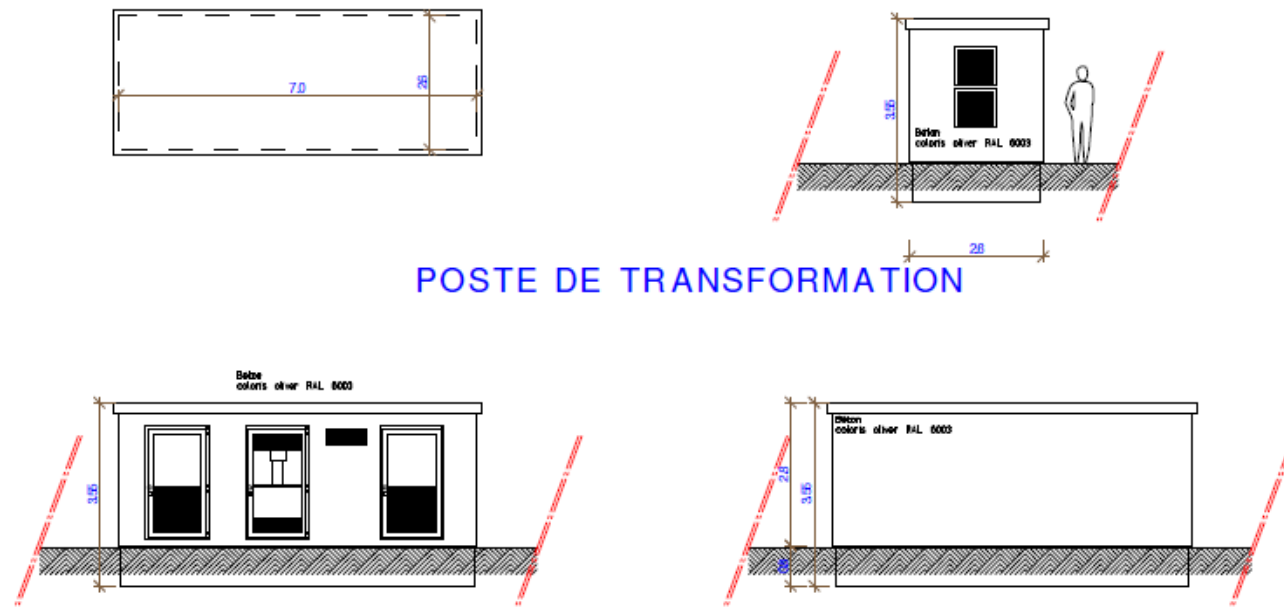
Exemple de poste de transformation et de livraison HTA/BT réhaussé (rehausse pssa, s.d.)
